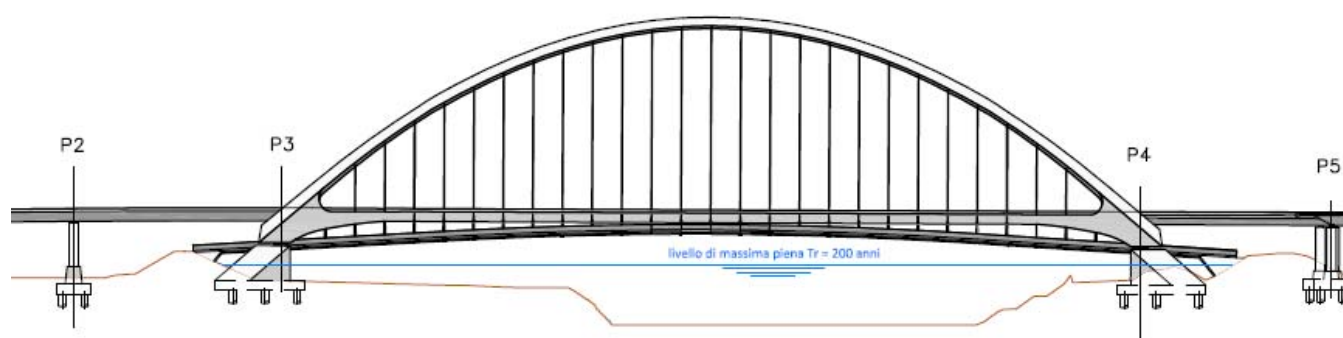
Prospetto longitudinale Ponte dei Congressi
